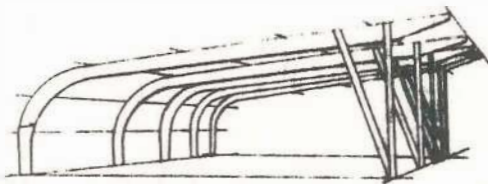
16. Distintos tipos de elementos estructurales en madera laminada
